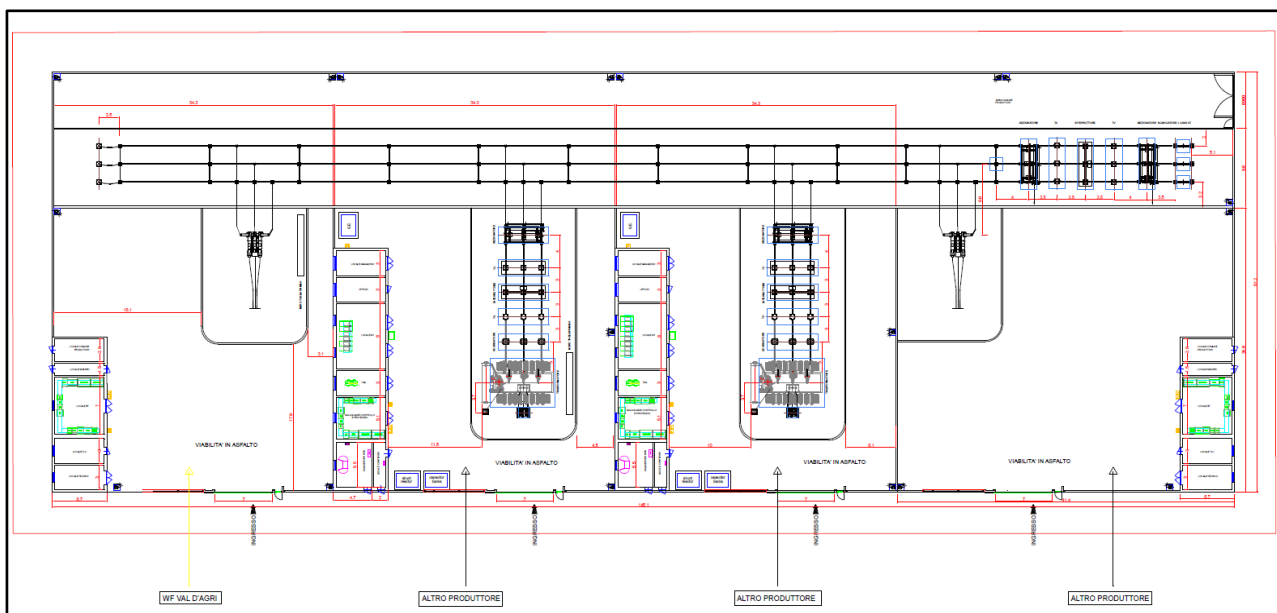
Planimetria elettromeccanica della sottostazione elettrica condivisa
